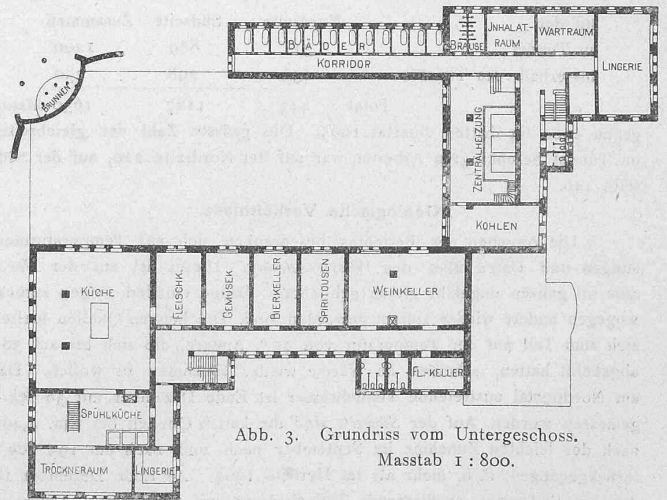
Grundriss vom Untergeschoss. Masstab 1 : 800.
